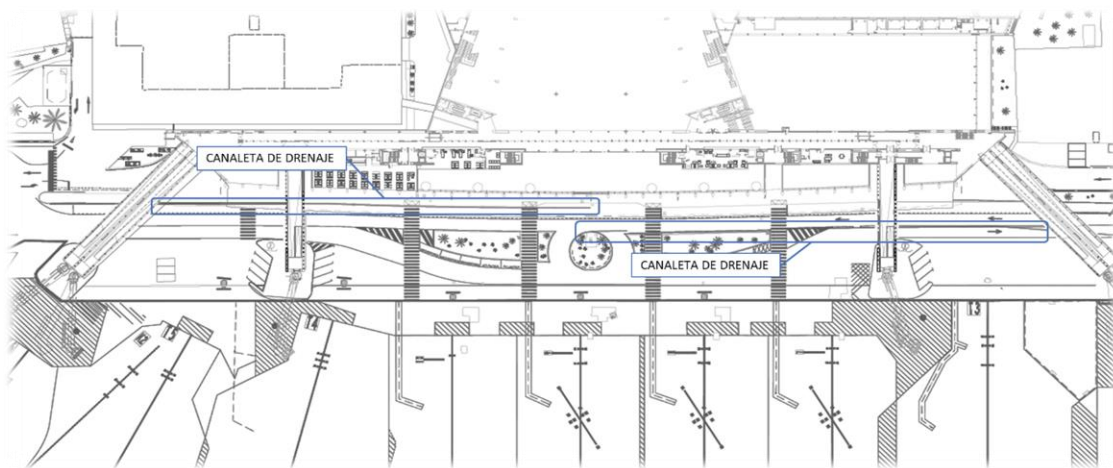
Situación de canaletas de drenaje en urbanización
